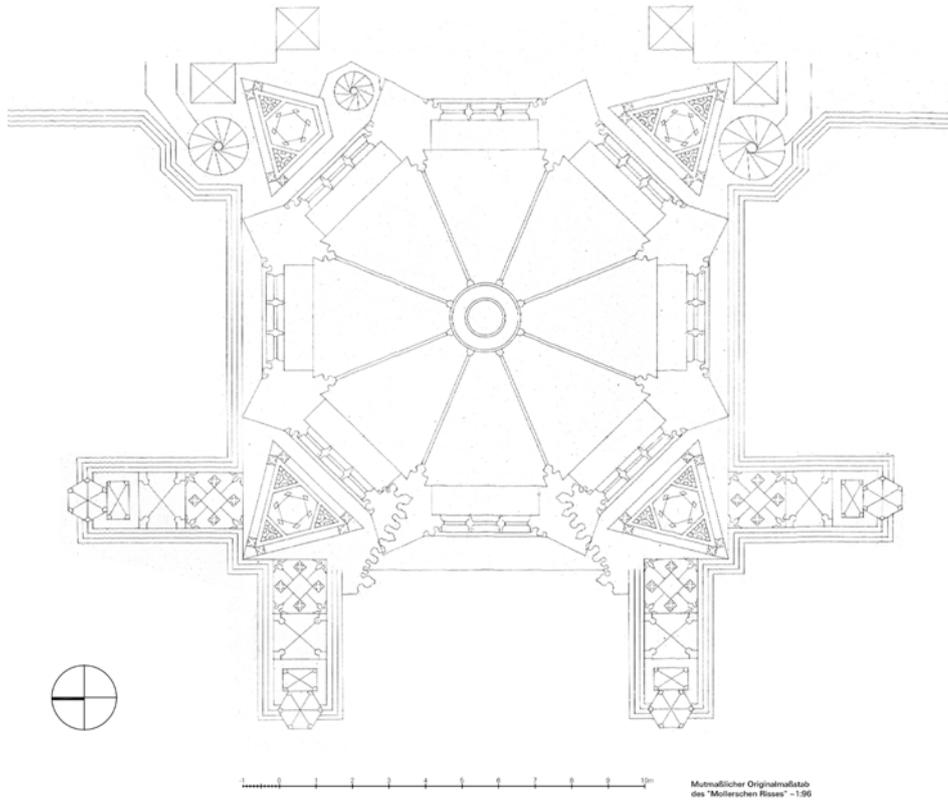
Die beiden einzigen Baurisse mit Grundrissdarstellung zum Münsterturm zeigen einen regelmäßigen oktogonalen Aufbau
